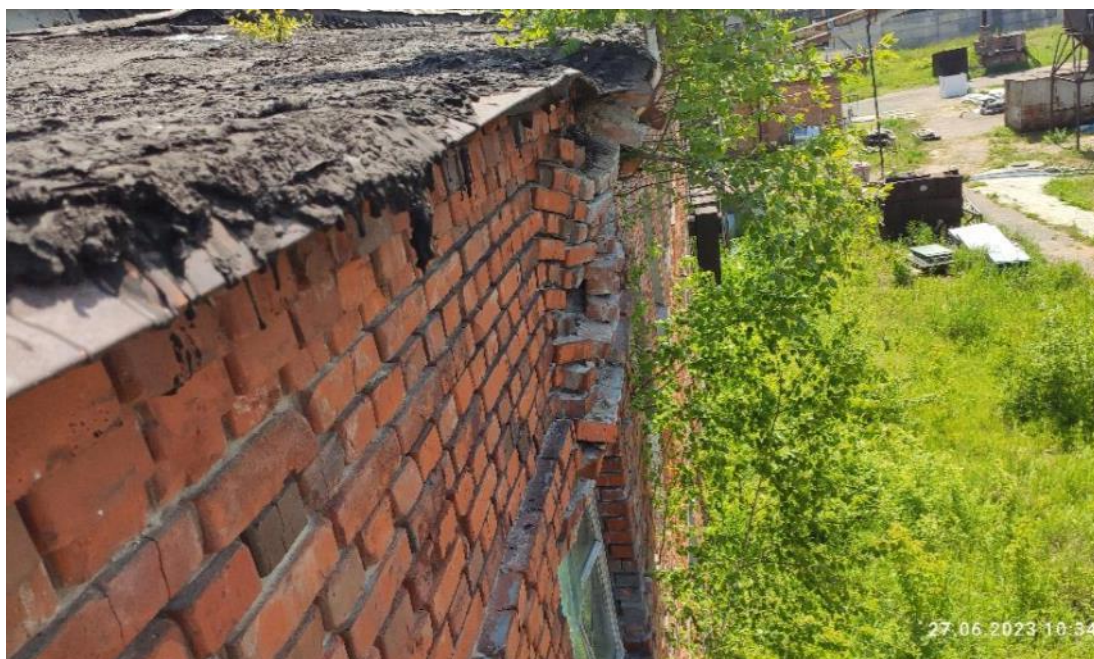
Разрушение кладки наружной версты. ОПАСНО!
